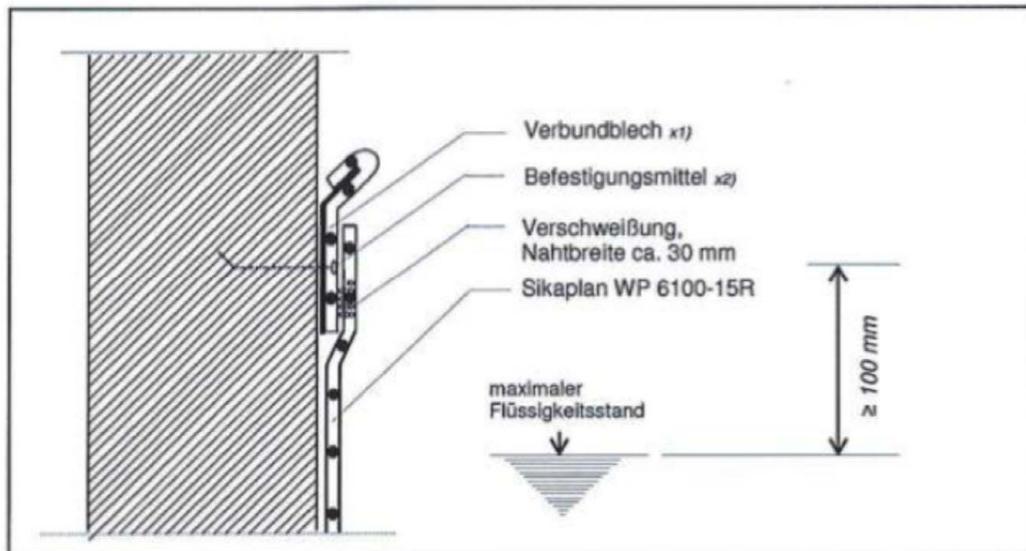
Randverwahrung mit kaschierten Blechen (Verbundblech, Detail A)
